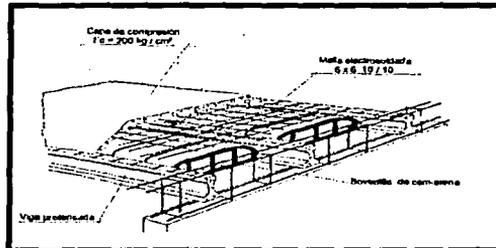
Conexión colada en sitio en un sistema vigueta y bovedilla.
